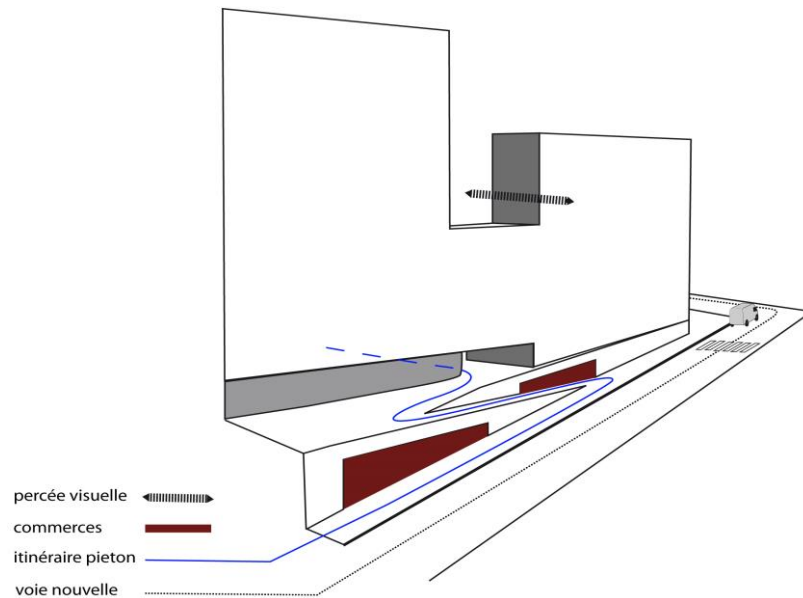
Schéma illustre le principe d'implantation de projet dans son site
